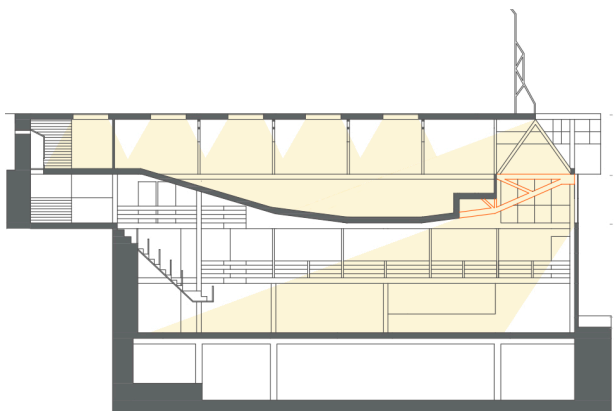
Sección transversal del Gimnasio Maravillas con esquema de la entrada de la luz.
